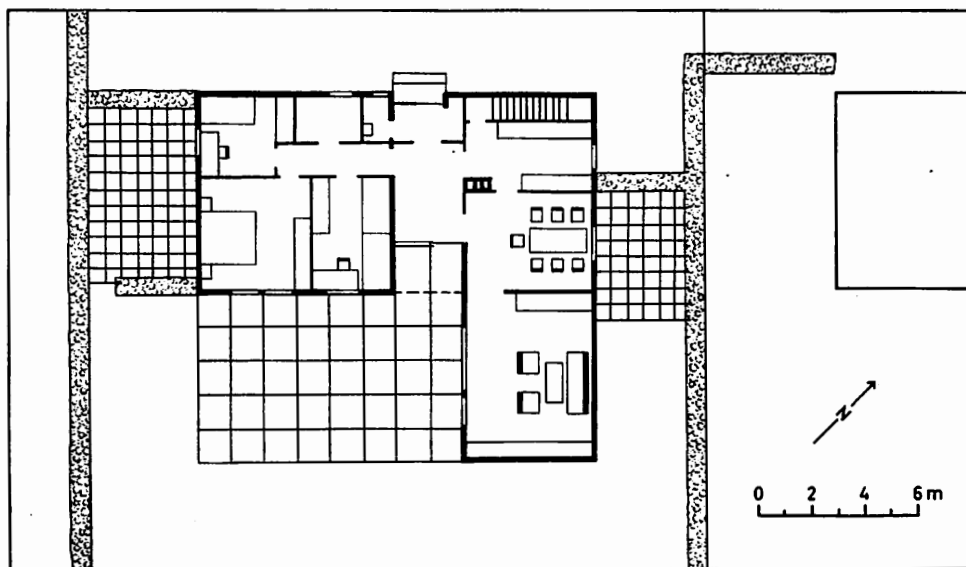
Grundriß eines typischen Einfamilienhauses (L-Grundriß, Zenker-Fertighaus) in offener Bauweise. Weitere Erläuterungen siehe Abschnitt 10.3.
